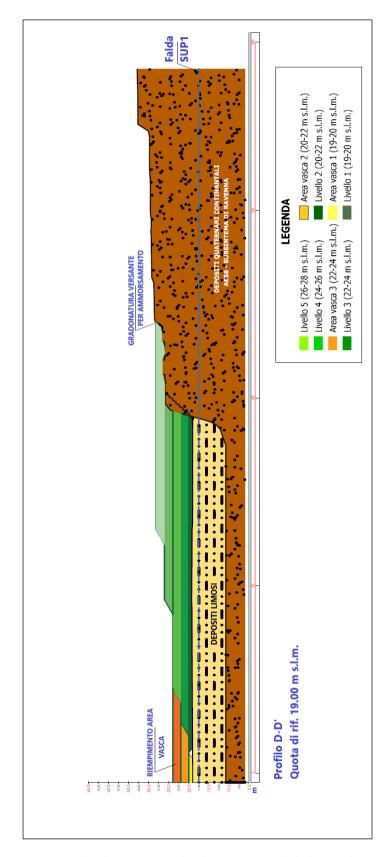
Sezione D- D' sul versante sud di Cava Olmi
